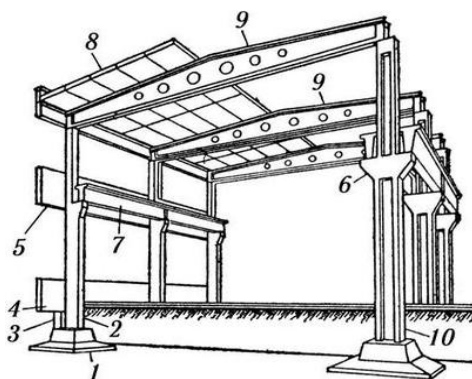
Схема одноэтажного промышленного здания с железобетонным каркасом: 1 – фундаменты под внутренние колонны; 2 – колонны наружного ряда; 3 – подкладка; 4 – фундаментная балка; 5 – стеновые плиты; 6 – консоли колонн; 7 – подкрановая балка; 8 – плиты покрытия; 9 – балки покрытия; 10 – внутренние колонны
